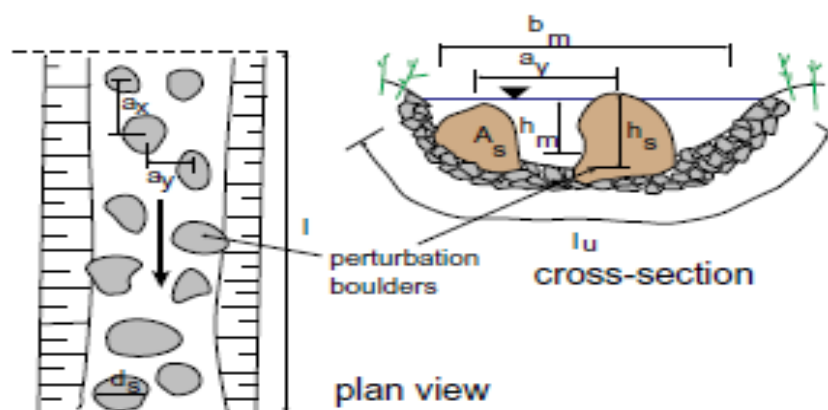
Schema progettuale passaggio di rimonta dell'ittiofauna tipo bypass
